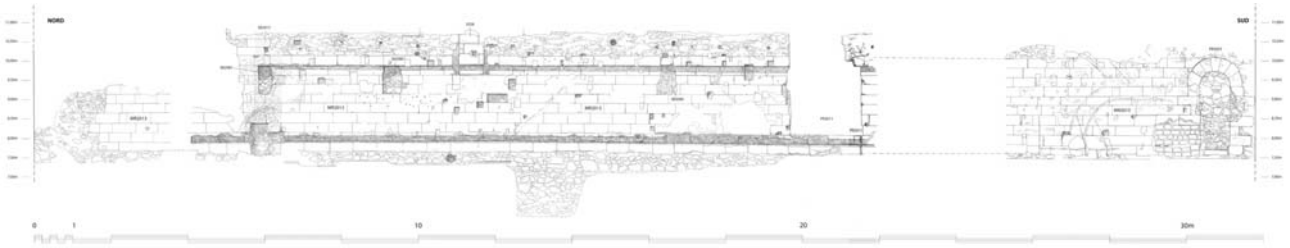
Le mur de brique de Marseille (13) © B. Sillano, Inrap
